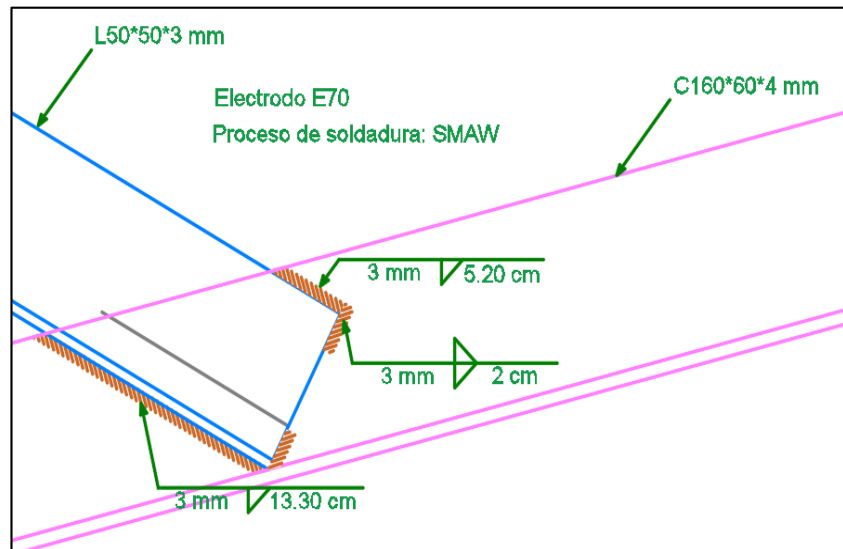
Detallamiento de Soldadura L50*50*3.
